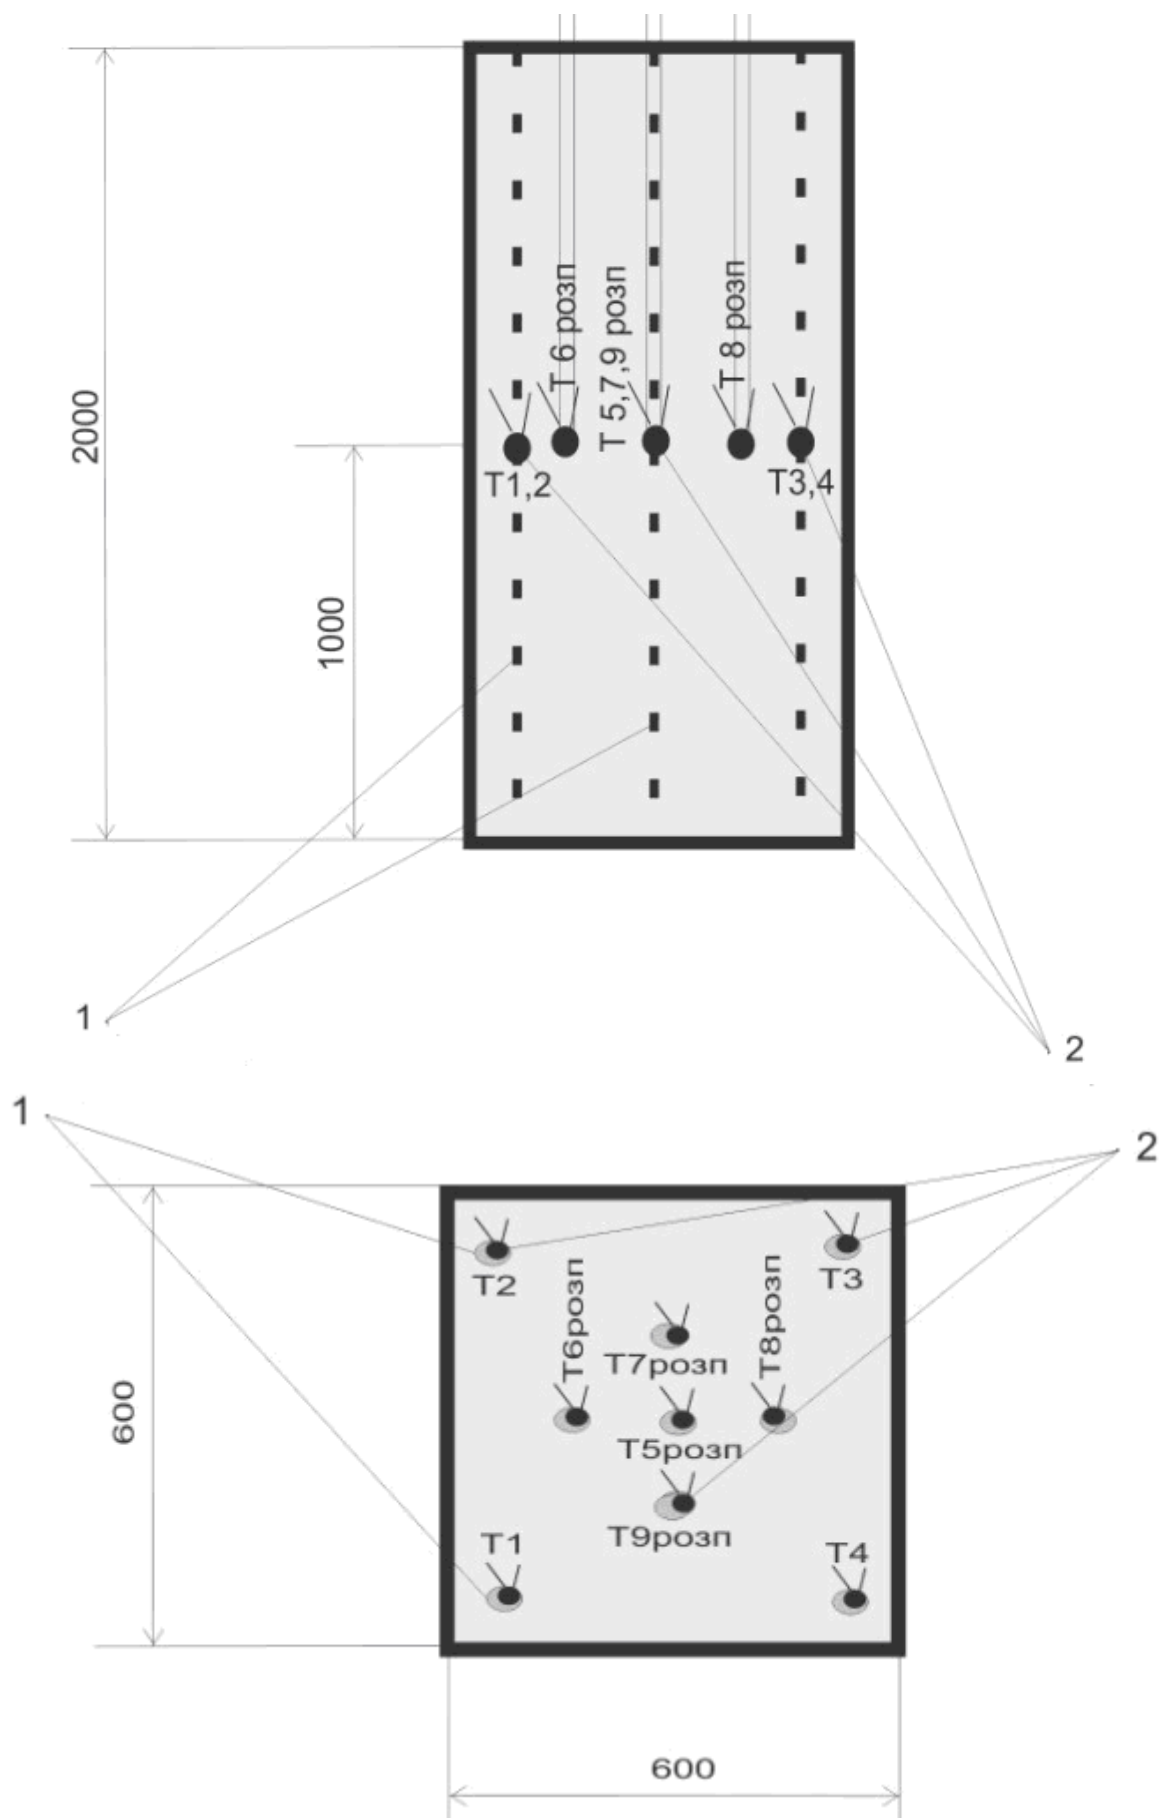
Схема розташування термопар на зразку: 1 – несучі арматурні стержні; 2 – термопари
